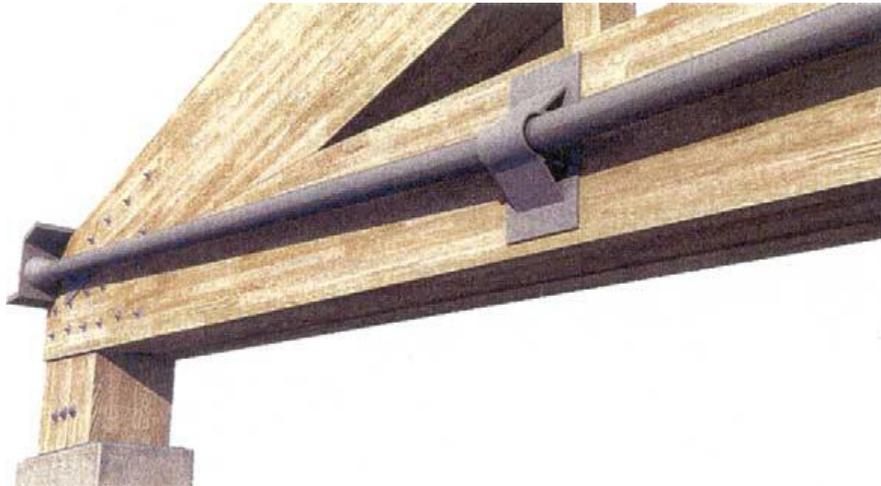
Consolidamento e recupero della struttura della Siemens Super Arena
